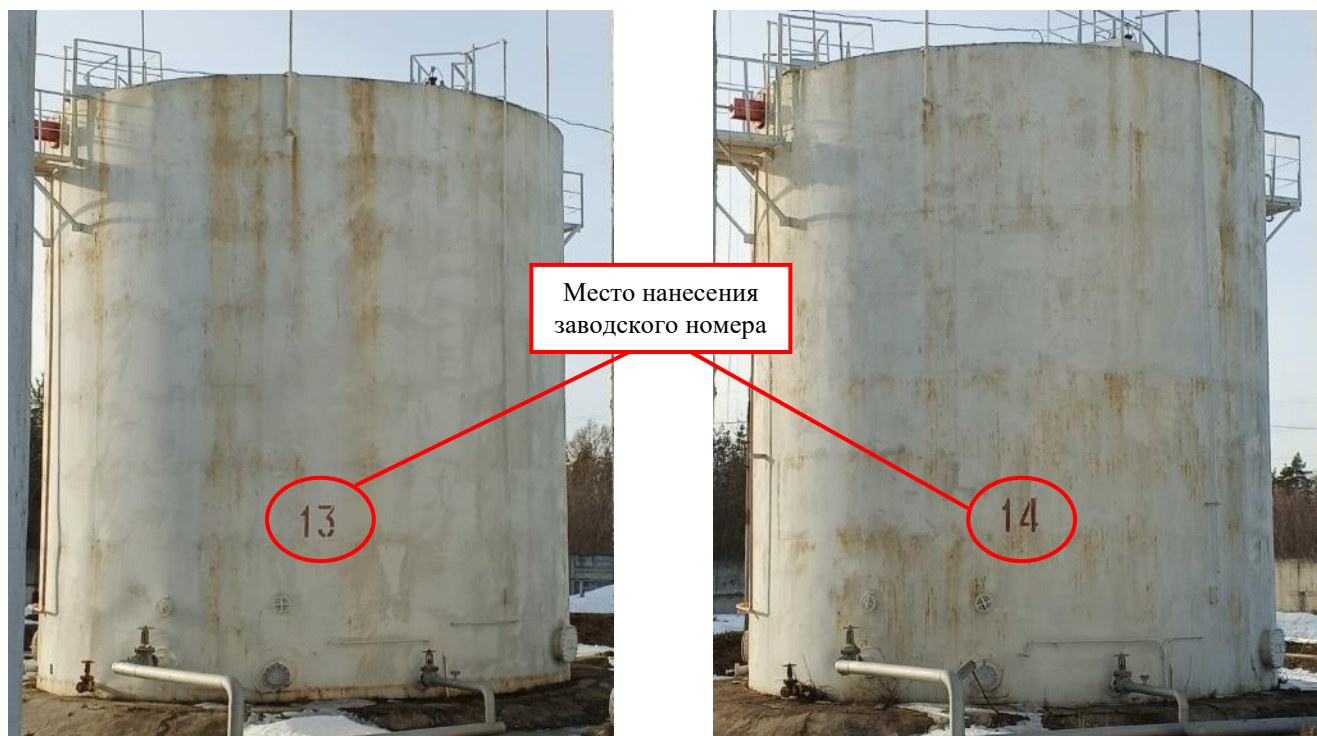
Общий вид резервуара стального вертикального цилиндрического РВС-1000 зав.№ 13, зав.№ 14
